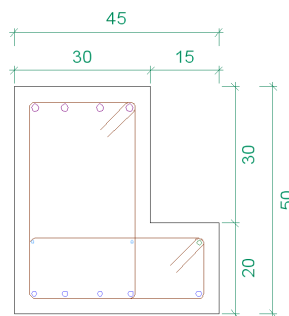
ESQUEMA DE SECCIÓN DE VIGA EN L
